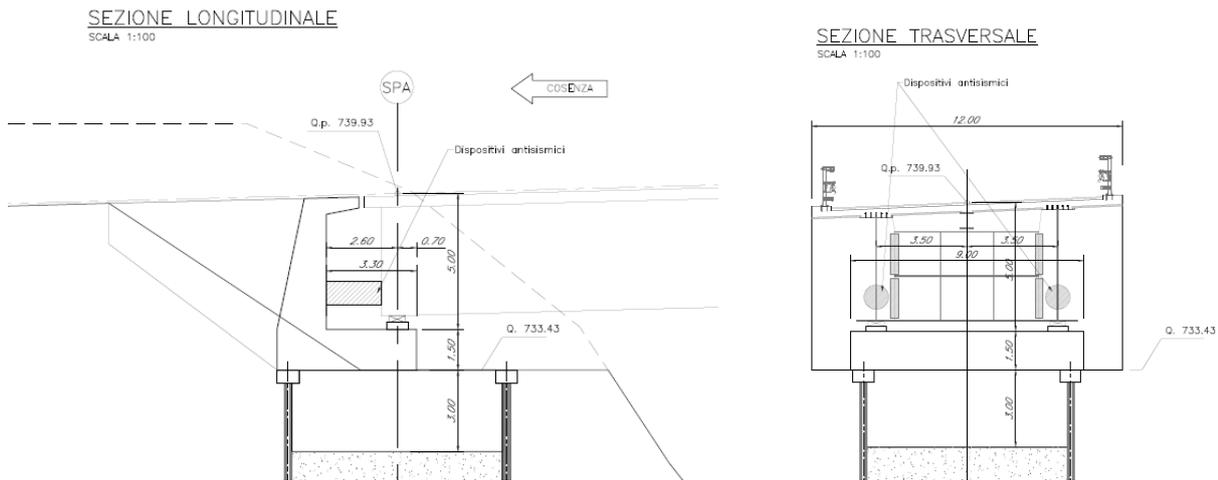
Sezione longitudinale e trasversale della Spalla A – Lato Cosenza – Dettaglio su Dispositivo sismico
